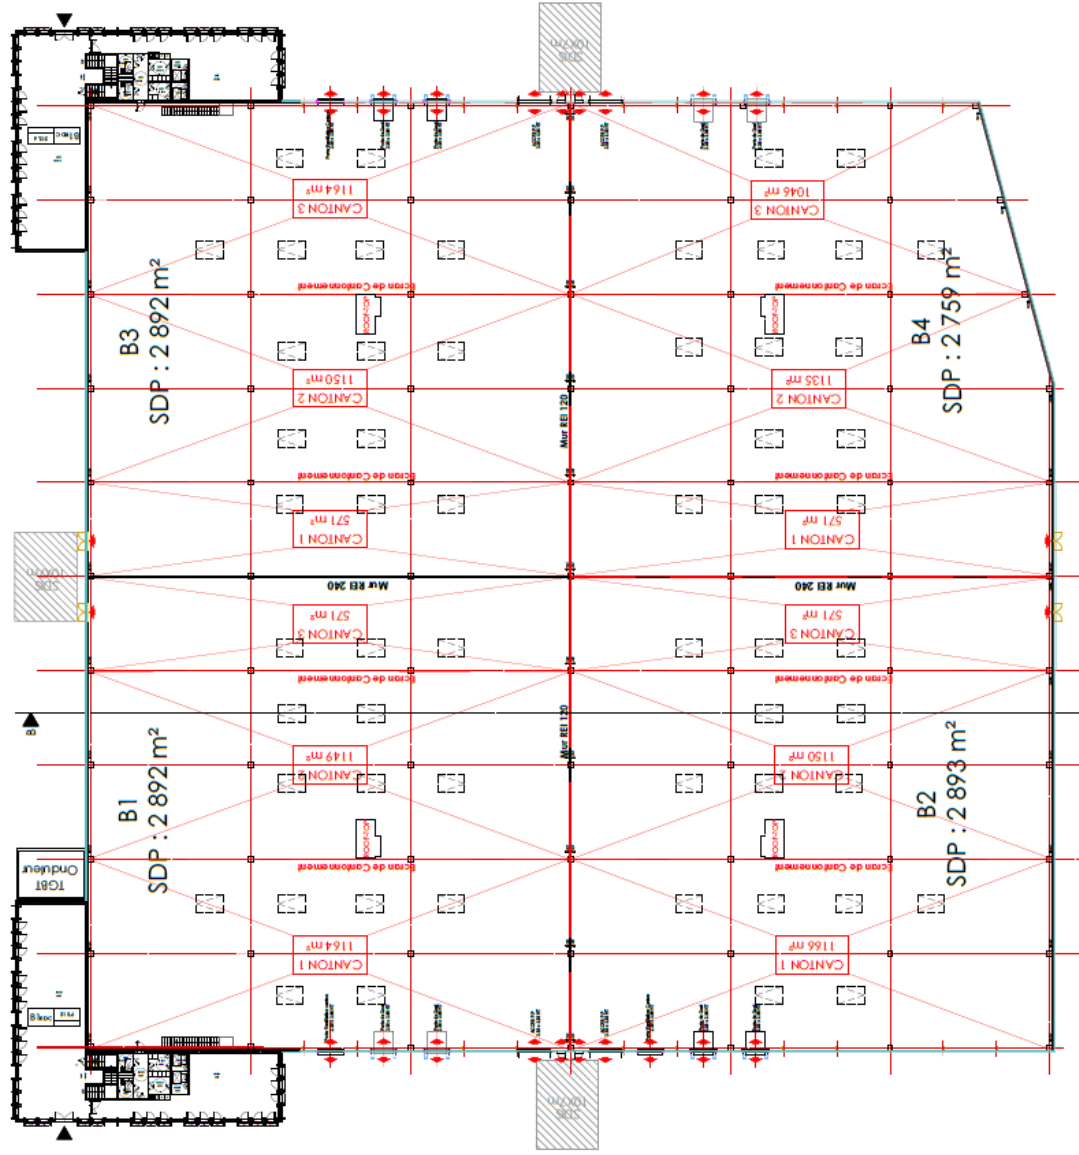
plan de cantonnement et de désenfumage du bâtiment B
